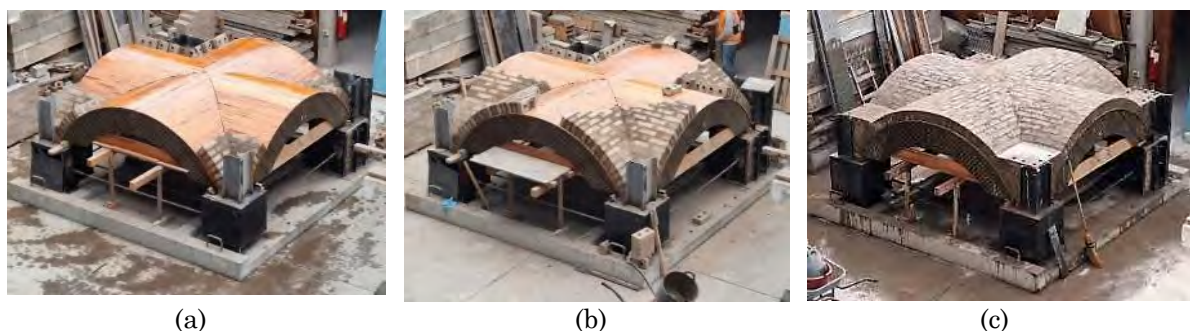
Construcción de bóveda de arista: (a) fase inicial, (b) media, y (c) final de la construcción.
